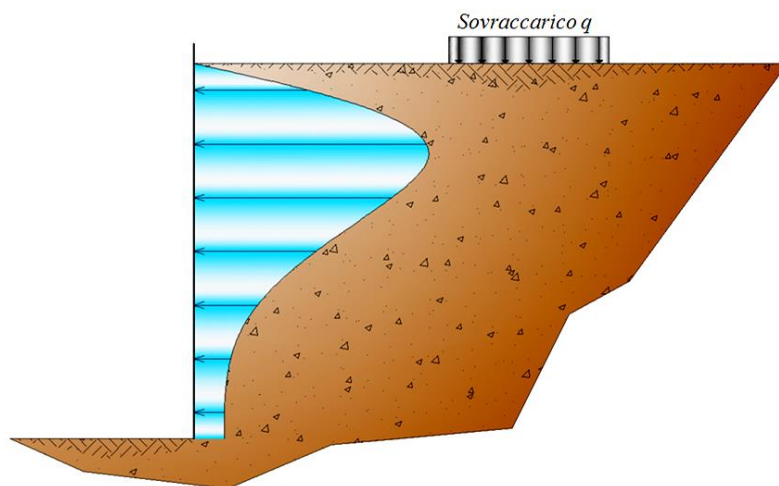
Pressione idrostatica agente sulla parete verticale
